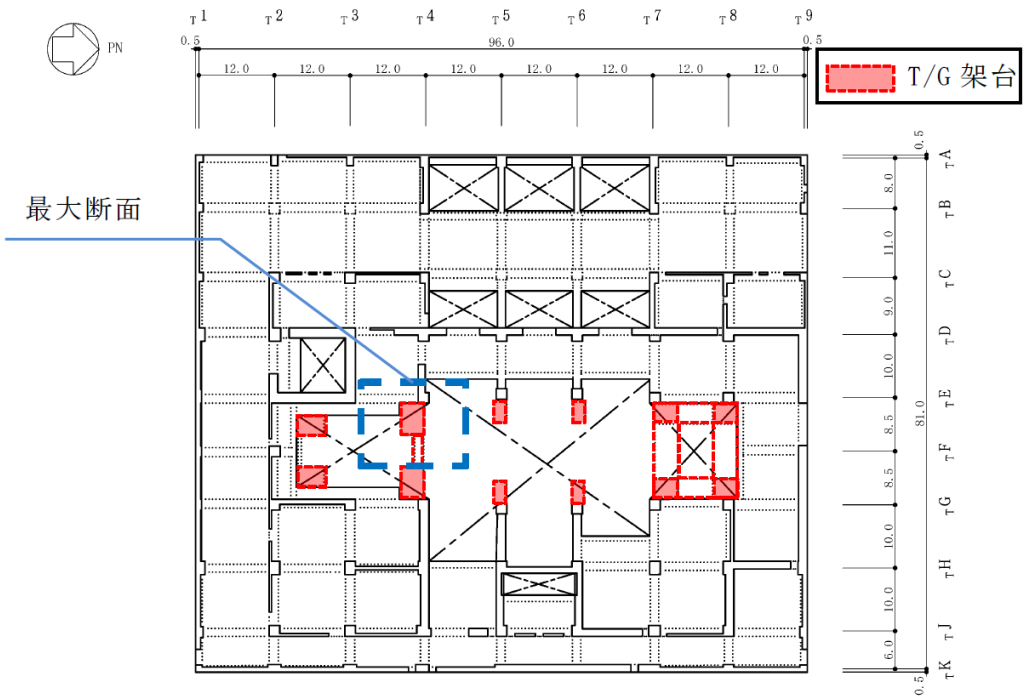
モデル化部の平面図 (1F, T.M.S.L. 12.3m) (単位 : m)
